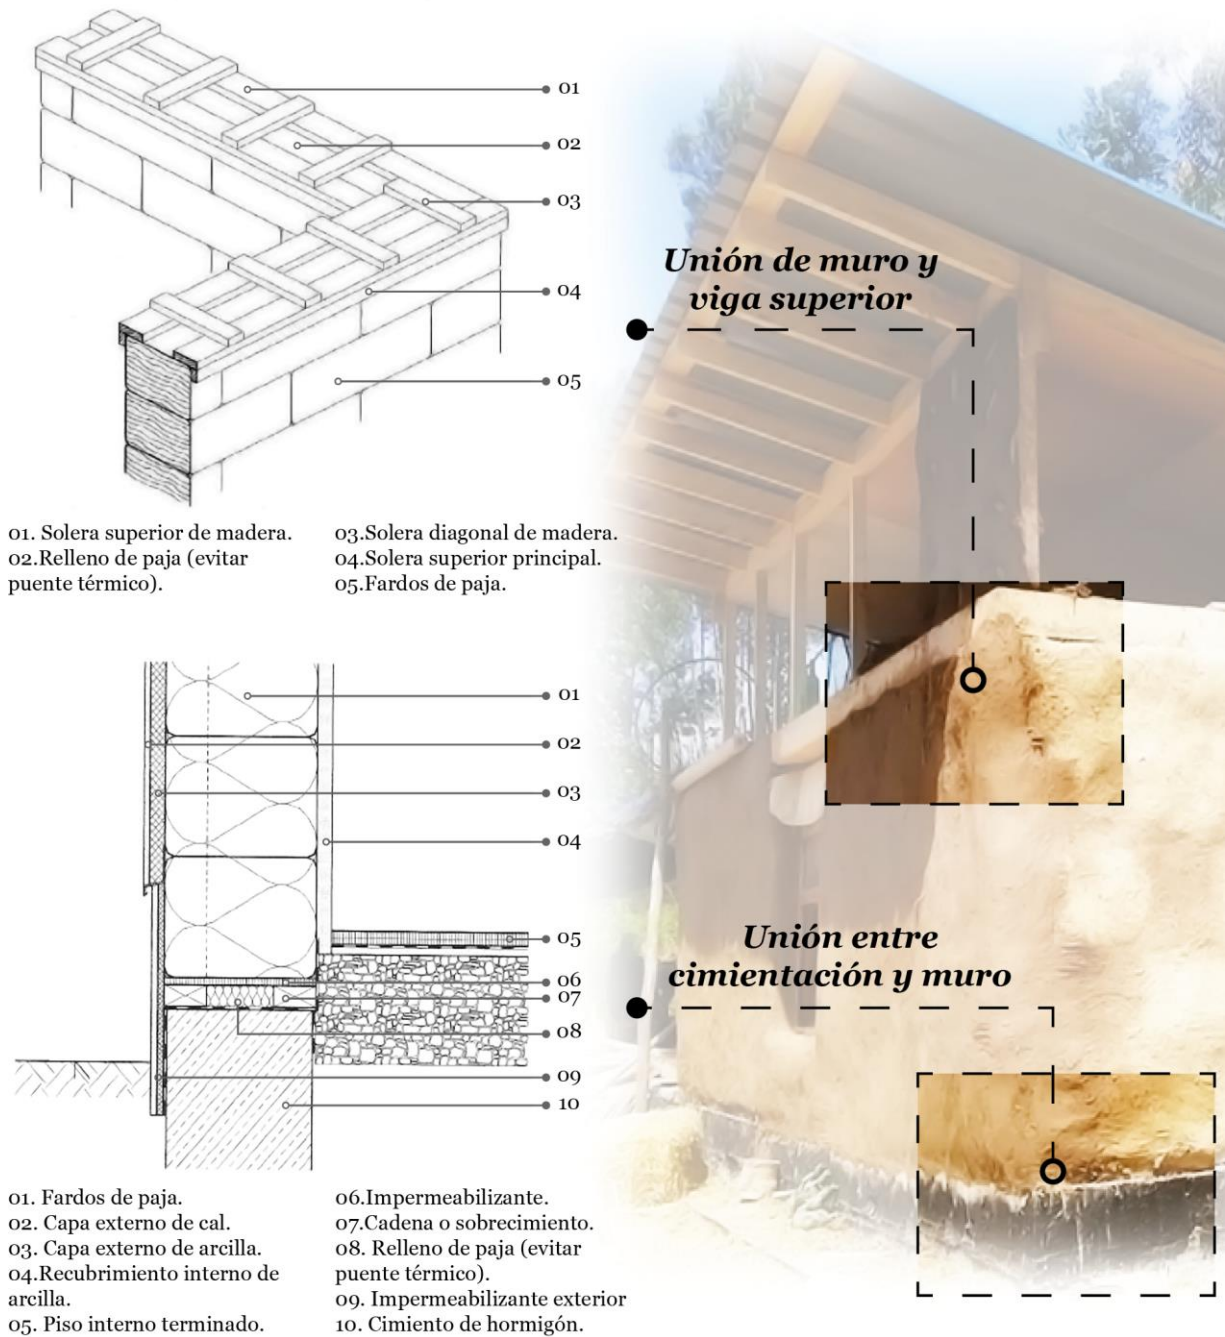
Detalles de uniones de cimentación, muro y viga superior
